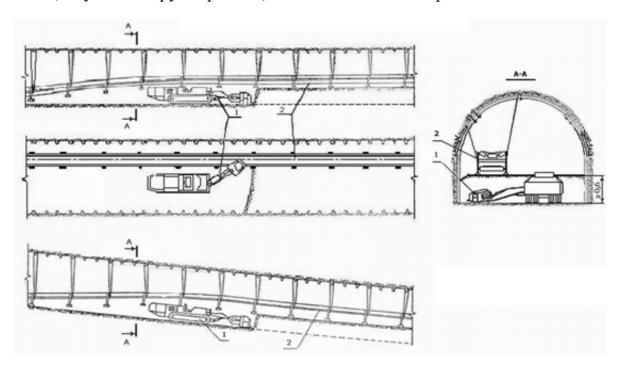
Схема размещения оборудования Условные обозначения: 1 — поддирочная машина; 2 — конвейер ленточный
